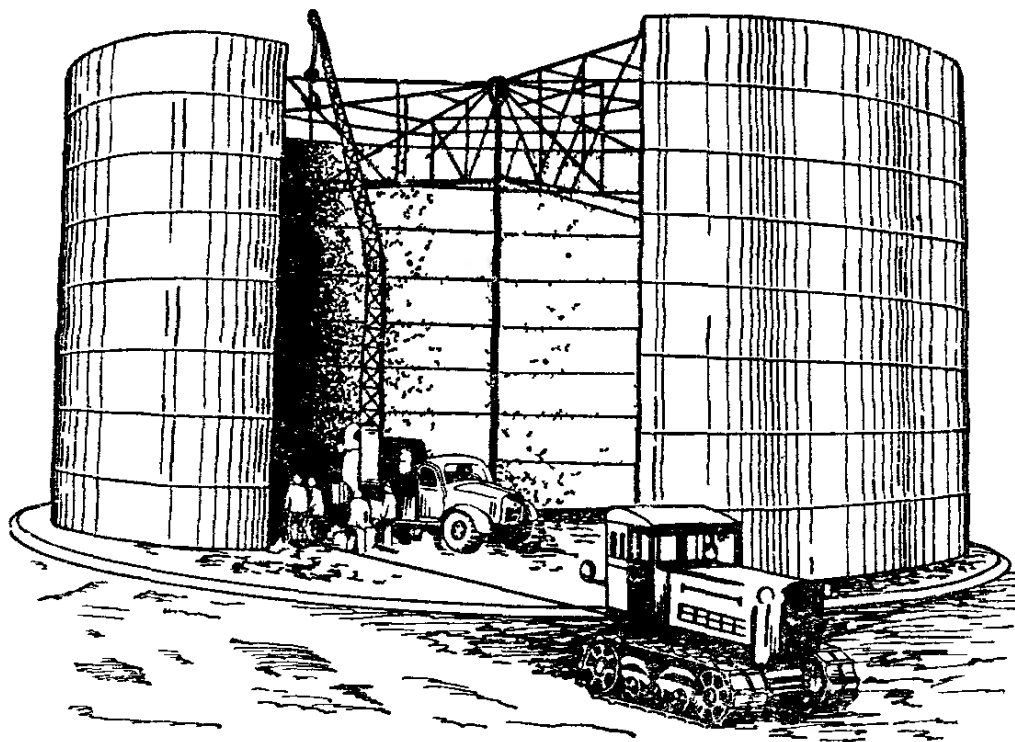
Развертывание рулона корпуса и монтаж ферм кровли при изготовлении нефтерезервуара
